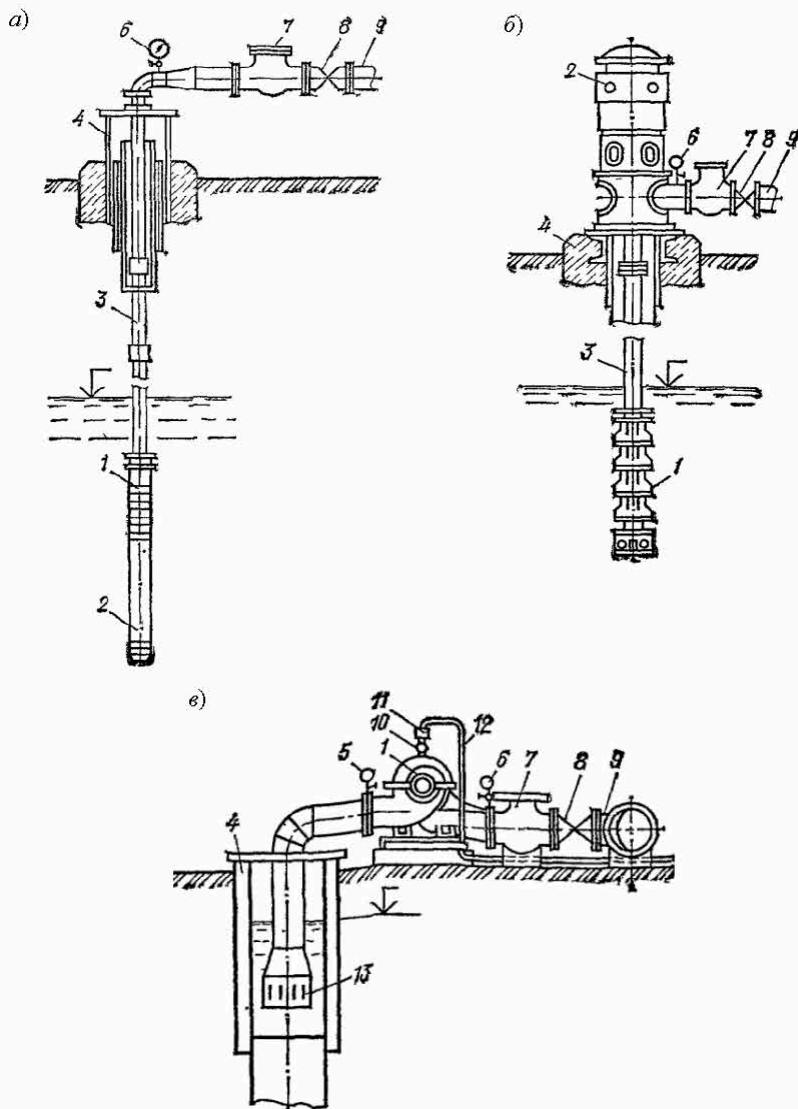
Схемы оборудования скважин насосами и арматурой:
